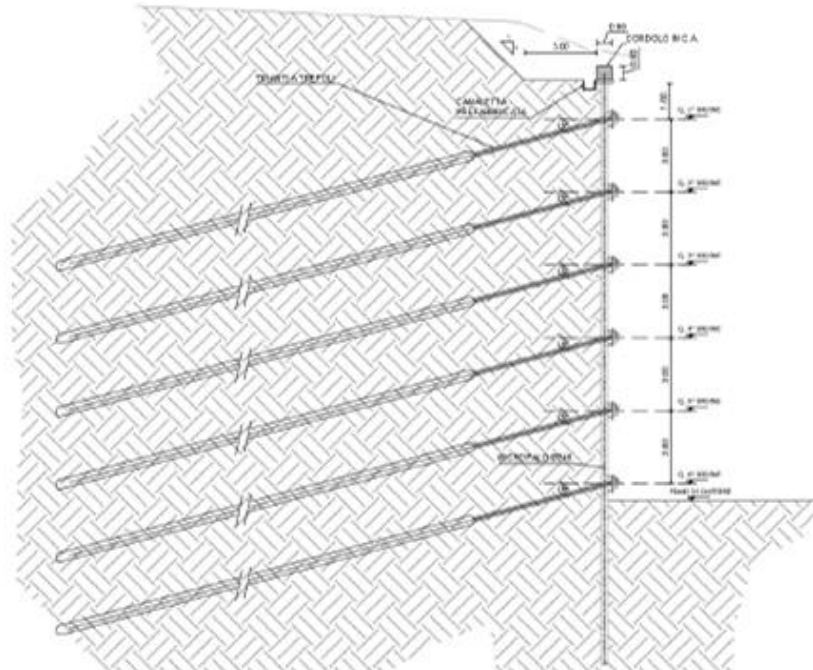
GA02 - Stralcio di planimetria della paratia d'imbocco
